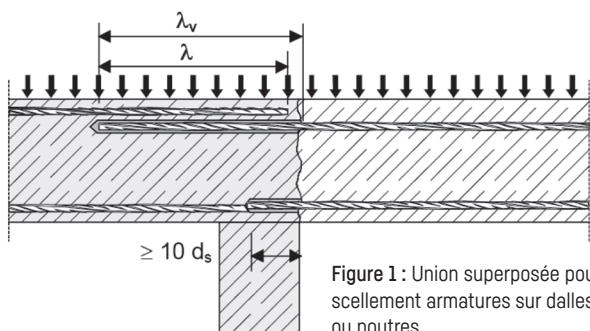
Union superposée pour scellement armatures sur dalles ou poutres.
